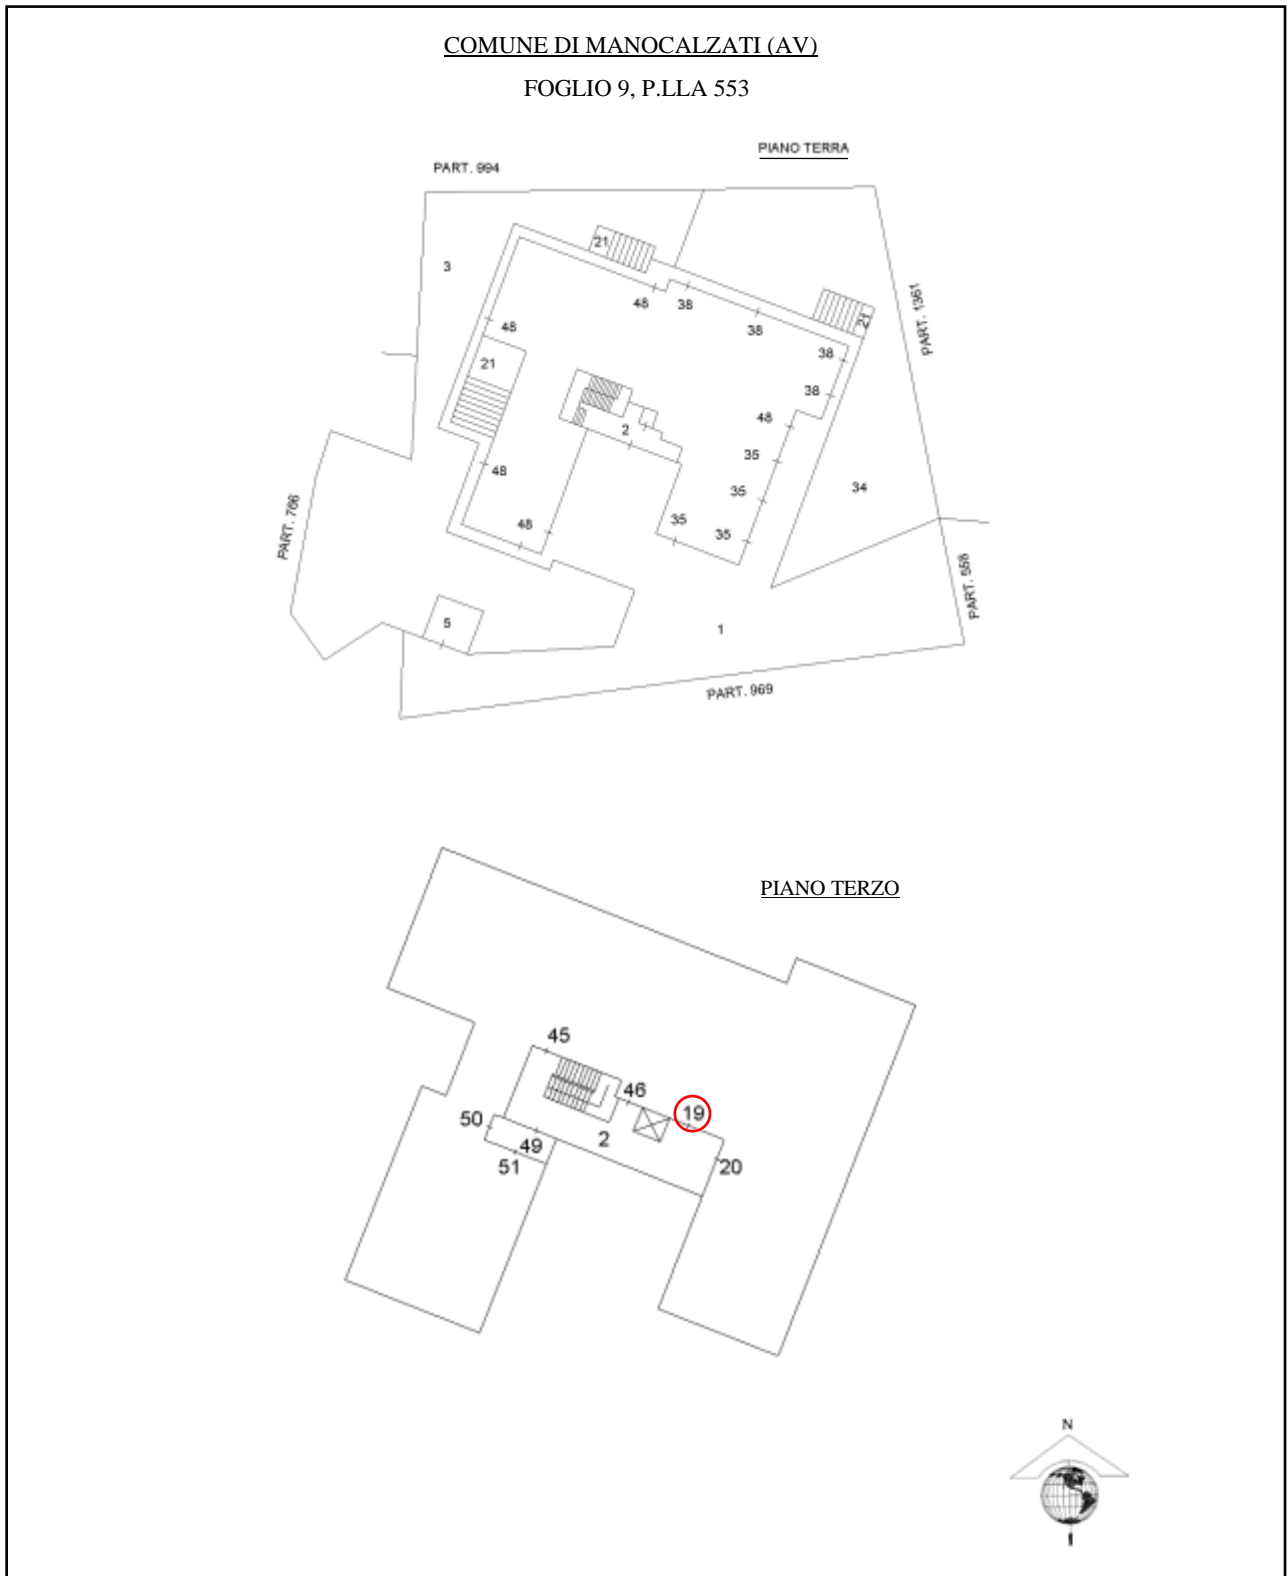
Stralcio elaborato planimetrico p.lla 553 con indicazione in rosso dell'unità immobiliare pignorata
